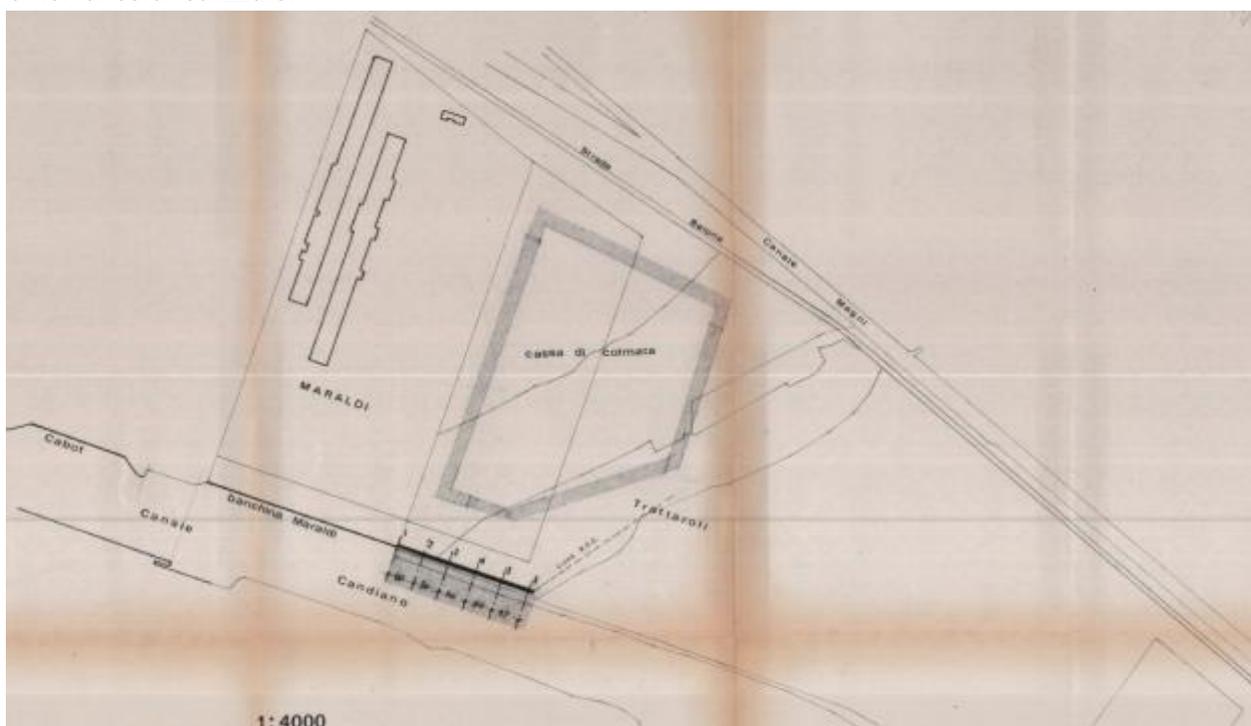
Planimetria generale del progetto di realizzazione del banchinamento del 1979
